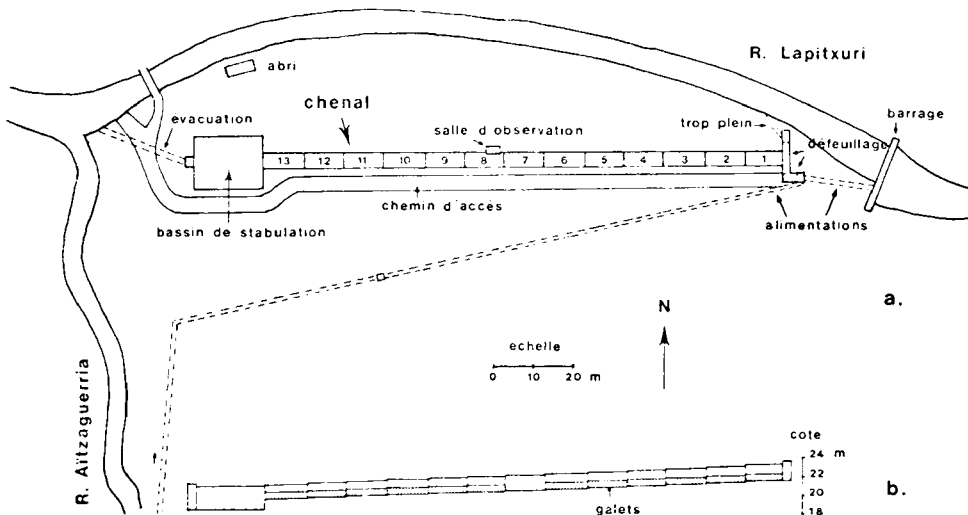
Plan (a) et coupe en long (b) du dispositif expérimental
